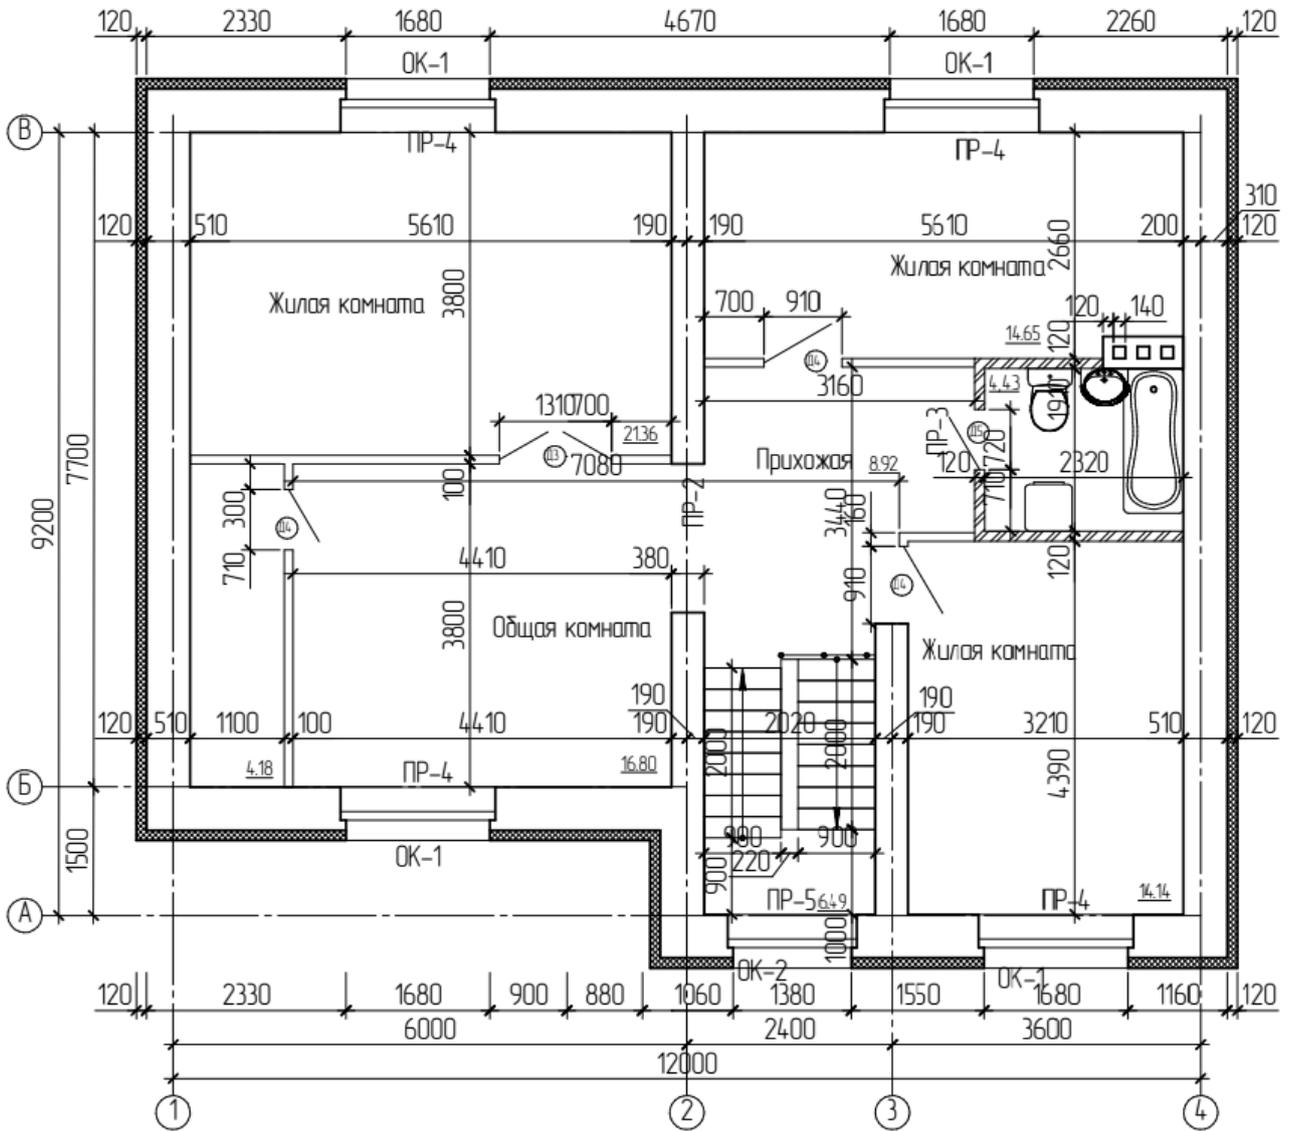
Пример выполнения плана 2-го этажа
